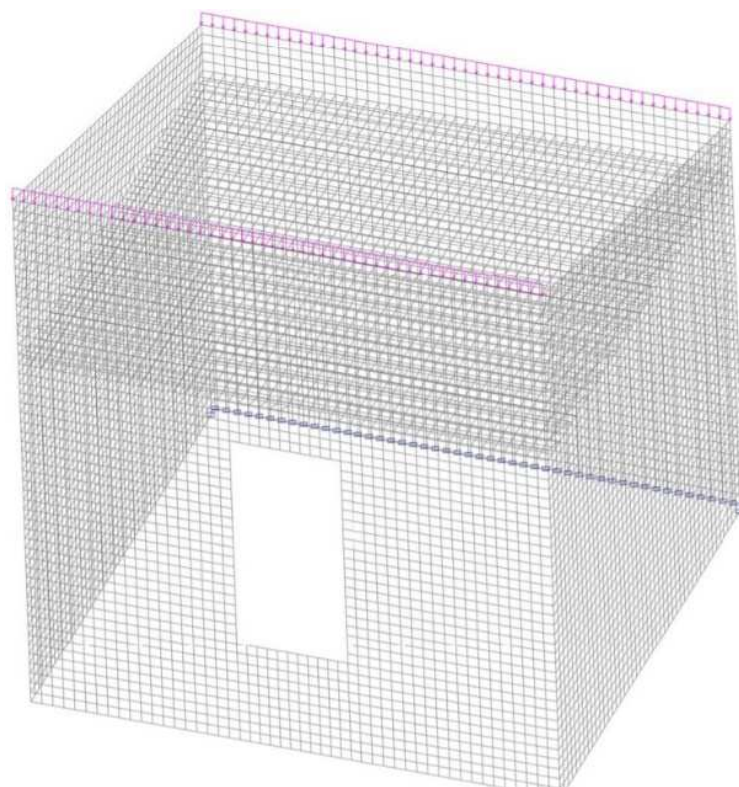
Общий вид постоянного нагружения от веса утеплителя на наружном перекрытии
